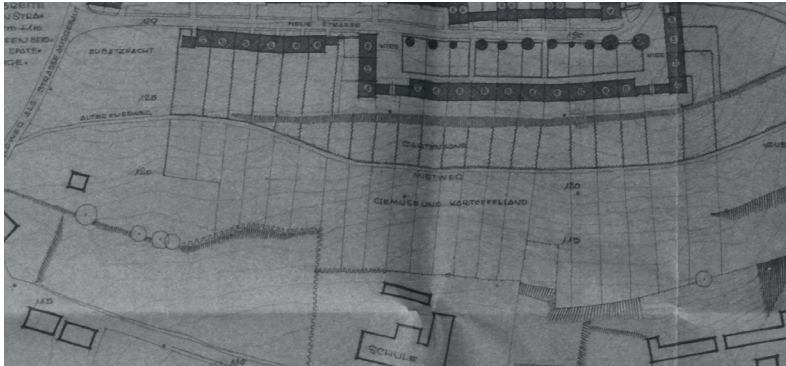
Büro Herbert Rimpl, Auerling-Siedlung, o.J., Lageplan mit Gemüsegärten
